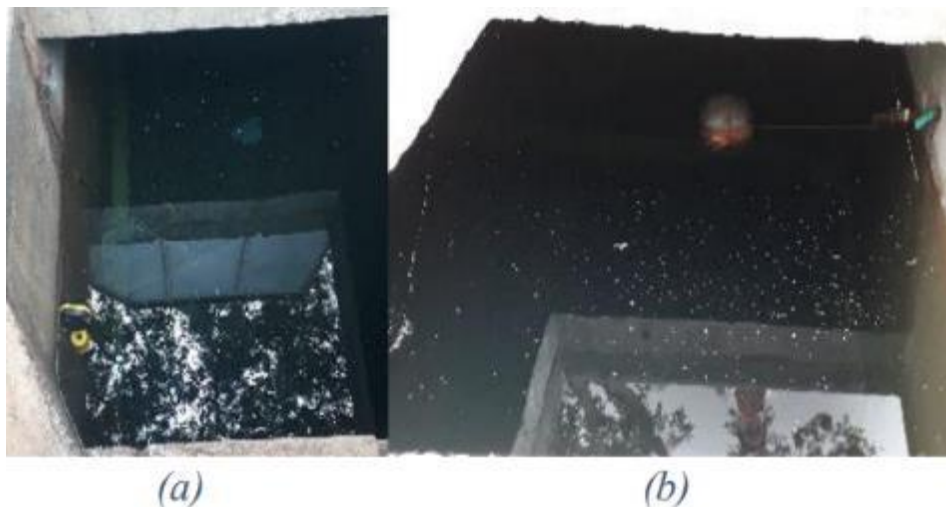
Caja de inspección adyacente al tanque de almacenamiento.
